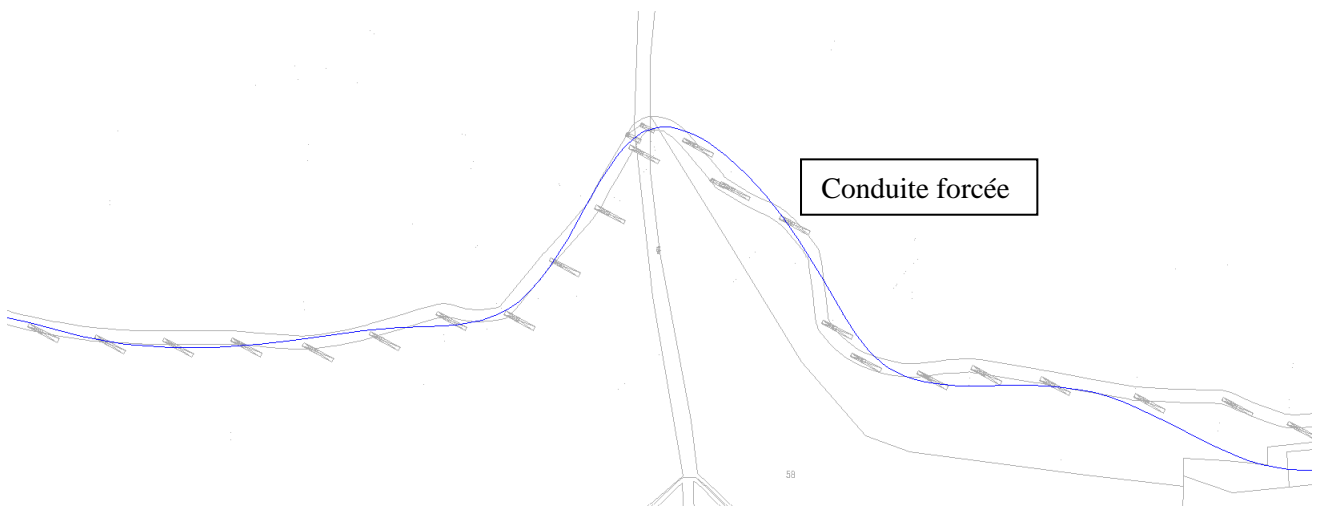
Implantation conduite forcée sur fond cadastral (3)
